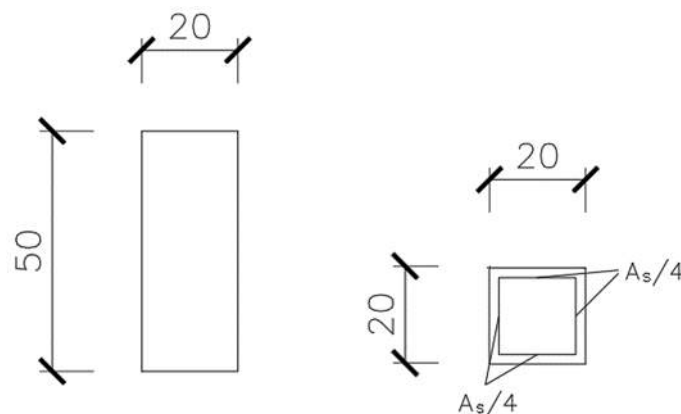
Corte transversal de viga y pilar derecho (A_s área total de acero).
